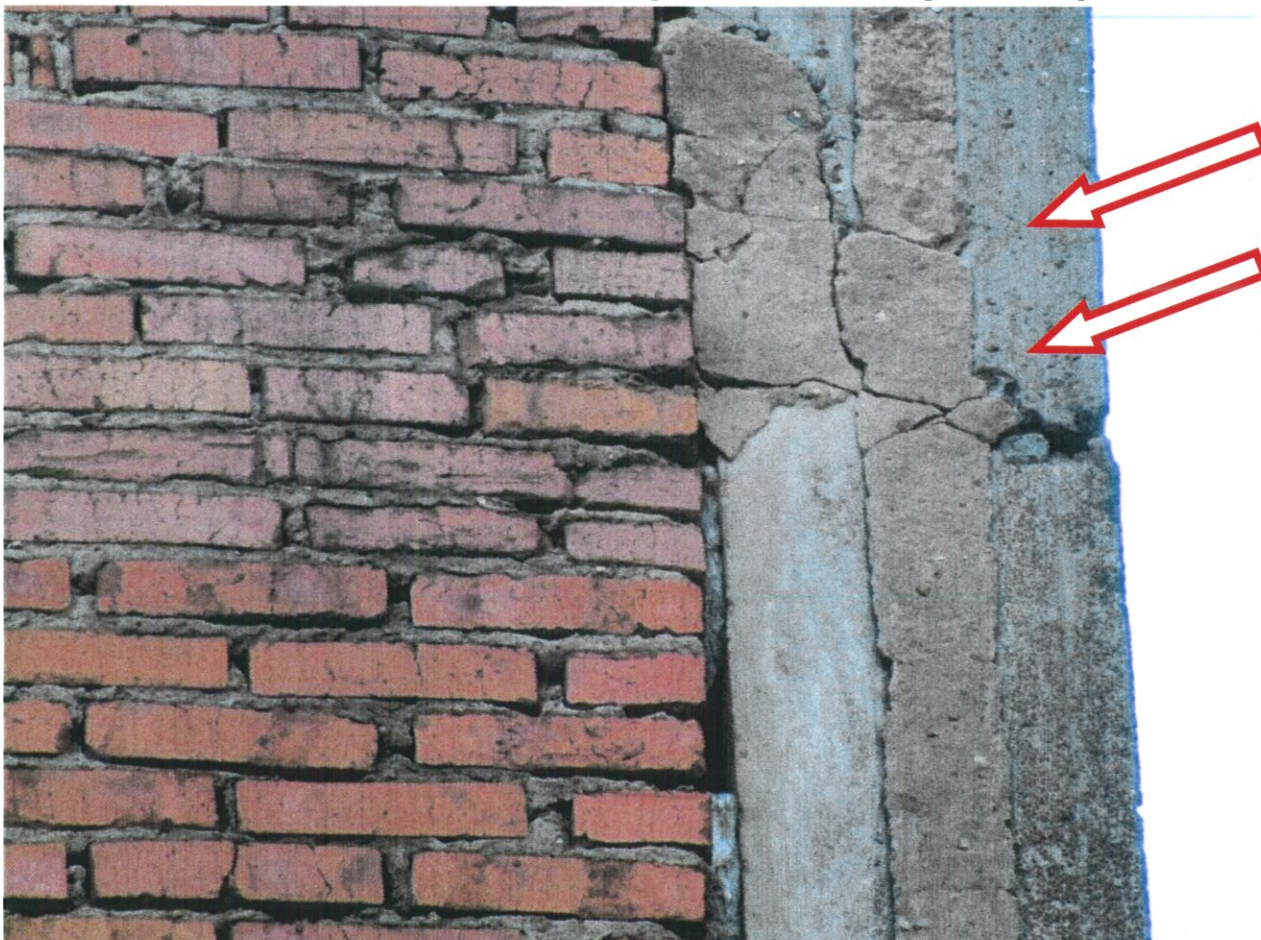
В торце здания цементная заделка примыканий каменной кладки торцевой стены к железобетонным панелям потрескалась и осыпается.
